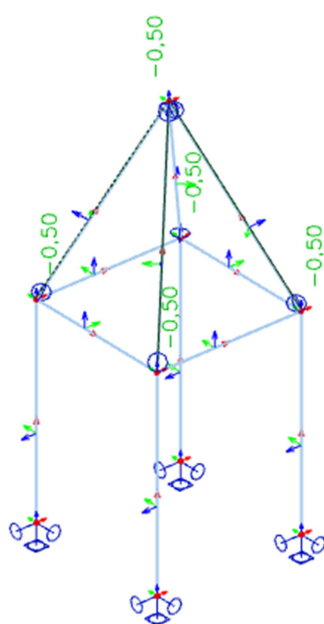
Konstrukce 1b, Zatěžovací stav ZS2
